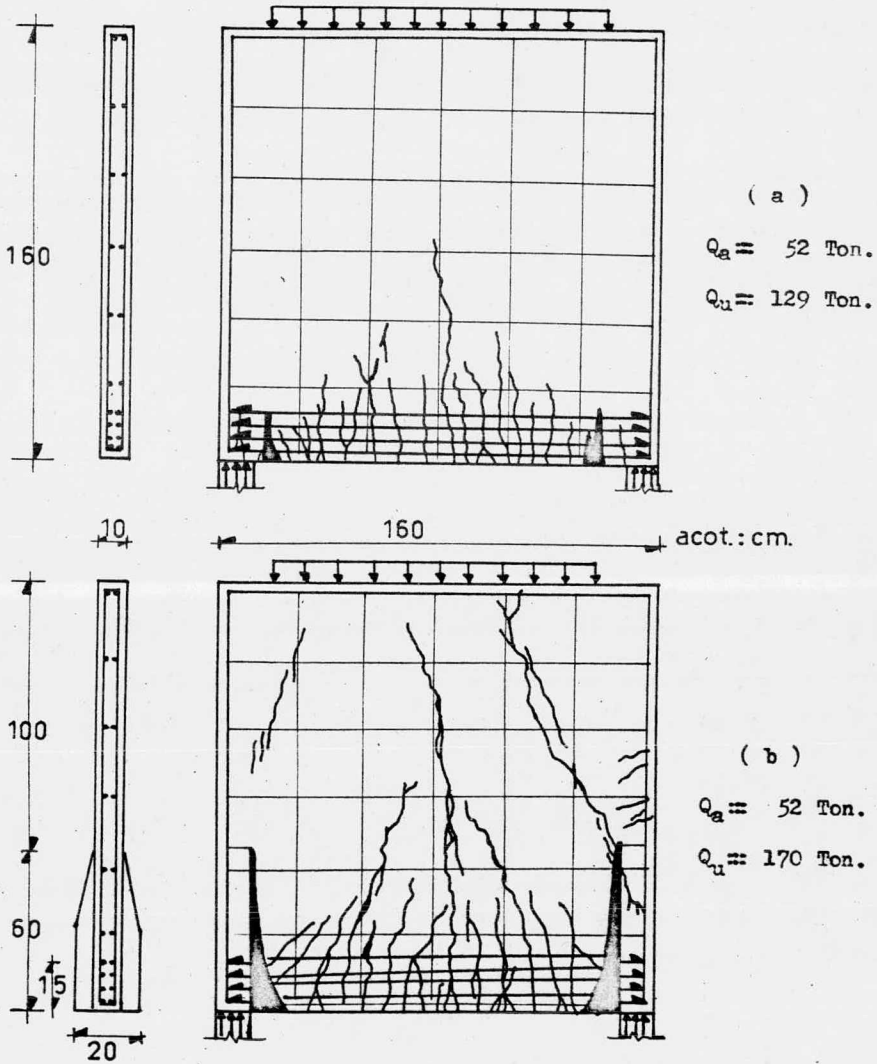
FALLA POR APLASTAMIENTO DE LOS APOYOS. VIGAS DE UN SOLO GIRO CARGADAS EN LA PARTE SUPERIOR.
